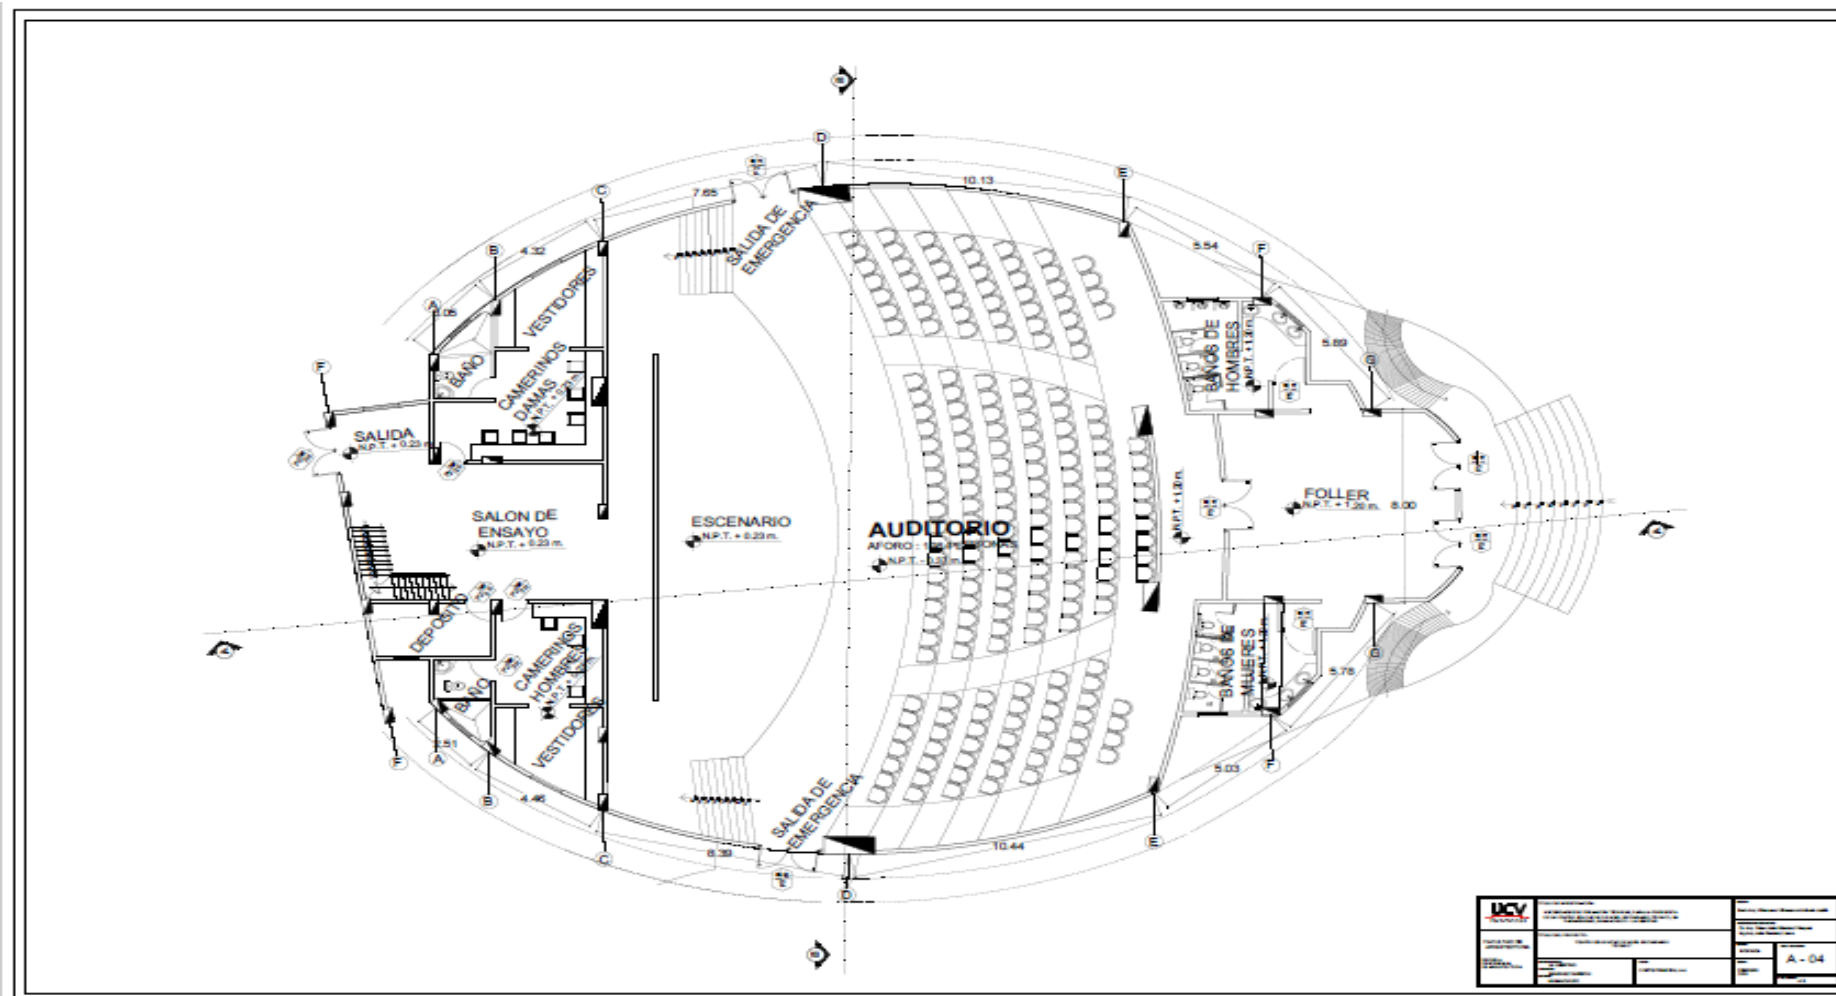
Plano de Detalles Arquitectonicos y/o Constructivos Especificos –Detalle Auditorio- Plano N° 35 - Lamina A-04
